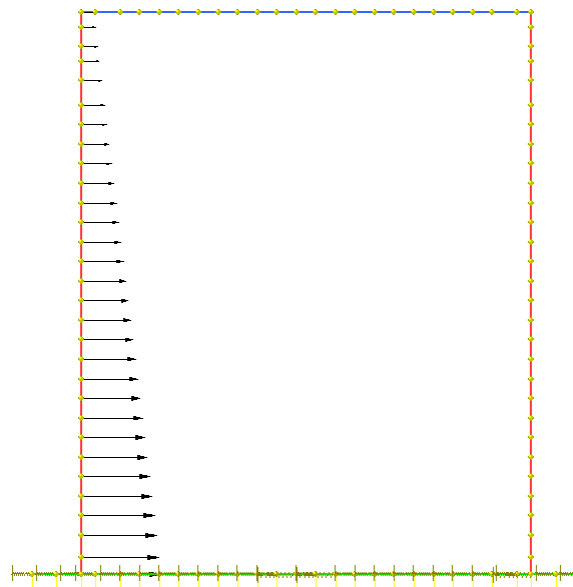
SPINTA ATTIVA DELLE TERRE SUL PIEDRITTO SINISTRO (CDC 8)
